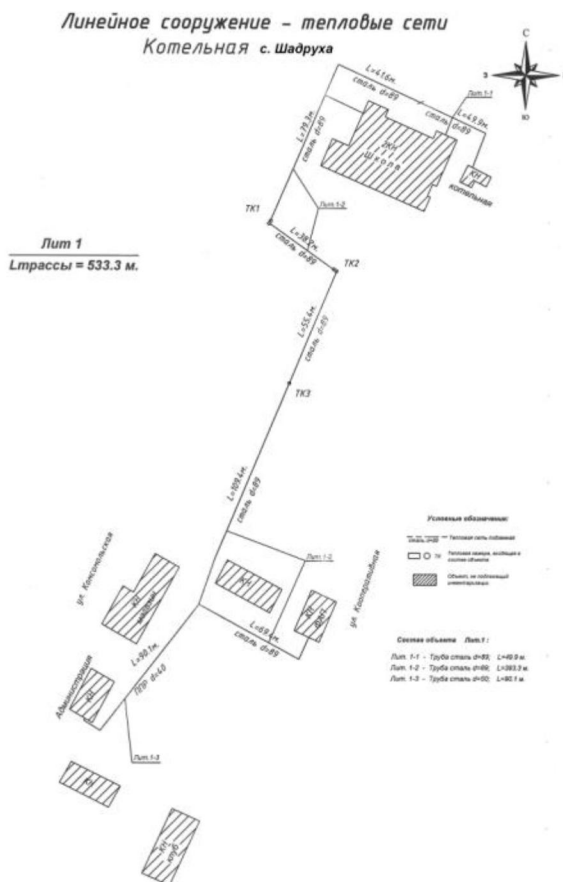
Схема тепловой сети котельной с. Шадруха
